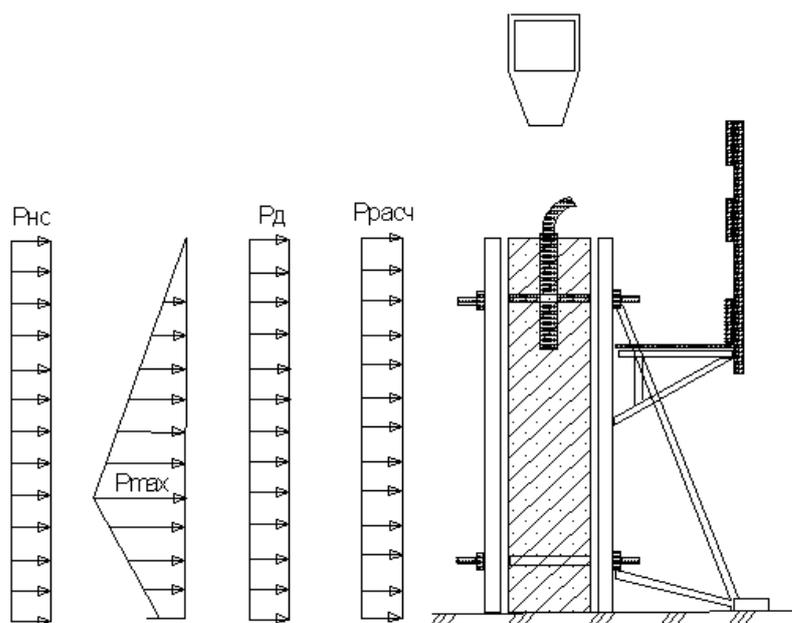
Расчетно-конструктивная схема опалубки стен
